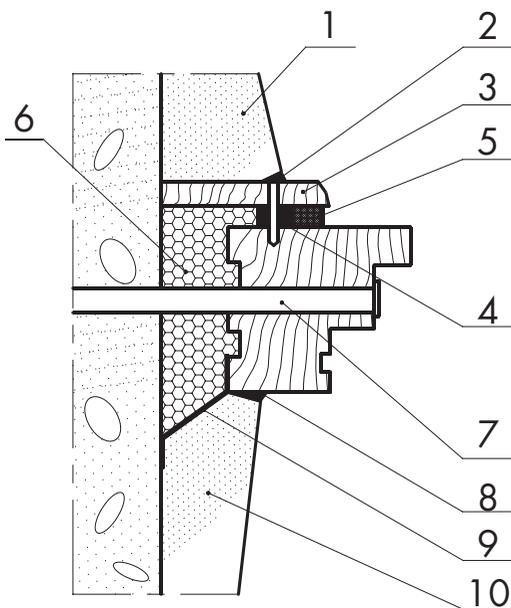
Узел бокового примыкания оконного блока к проему без четверти в стене из ячеистобетонных блоков с отделкой, наружных и внутренних откосов штукатурным раствором
